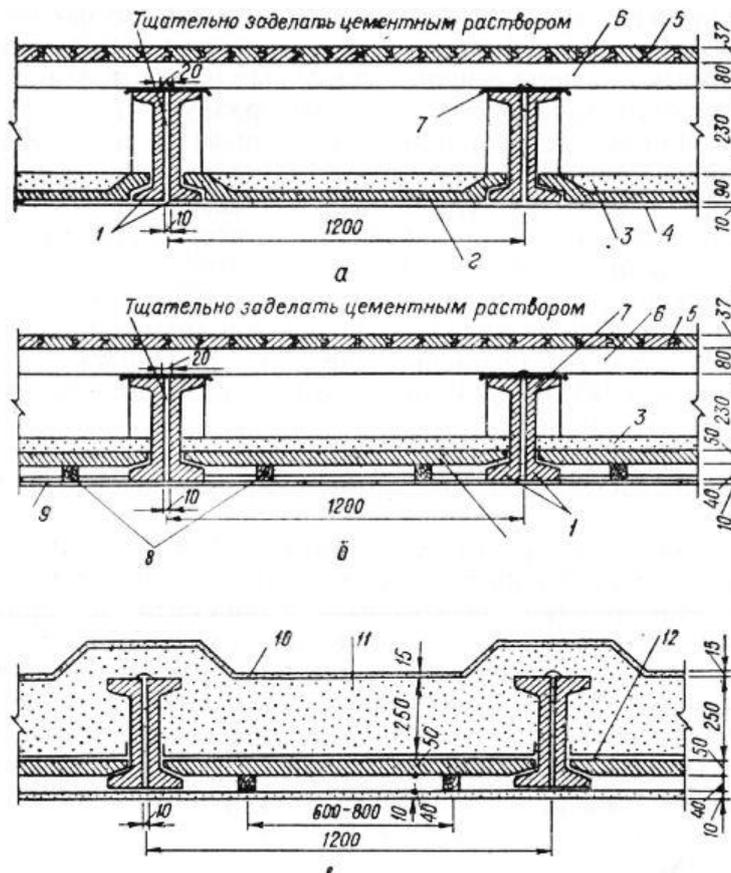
Московская конструкция сборного перекрытия из железобетонных швеллерных балок и плит с устройством пола:
